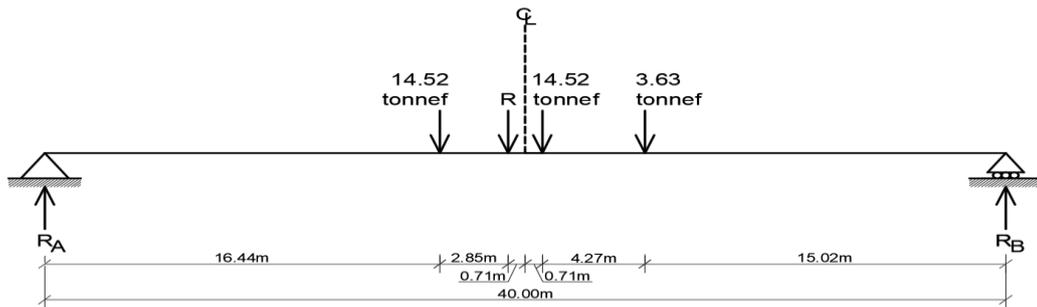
Carga viva de camión HS20-44 aplicada sobre la viga metálica
